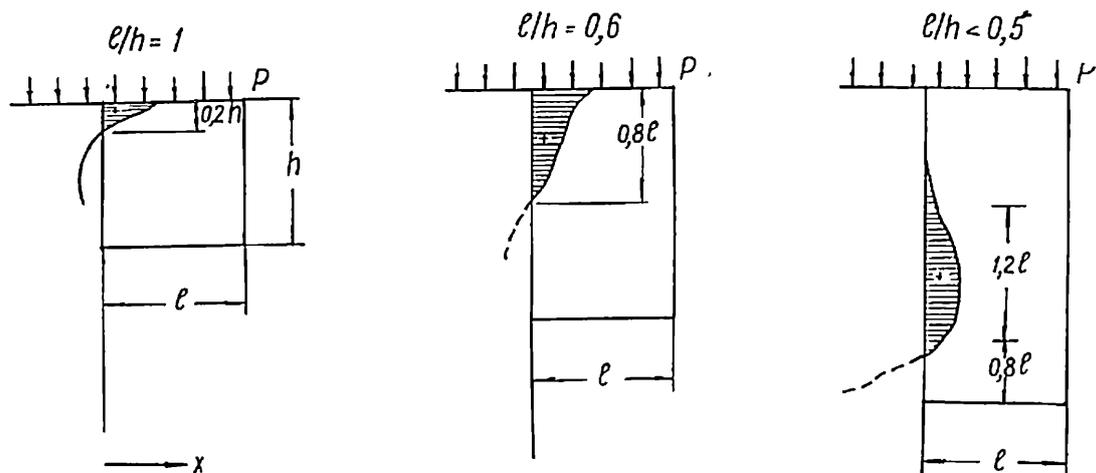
9. Распределение в опорном сечении напряжений σ_x и размещение основной арматуры по высоте у консольных балок-стенок
